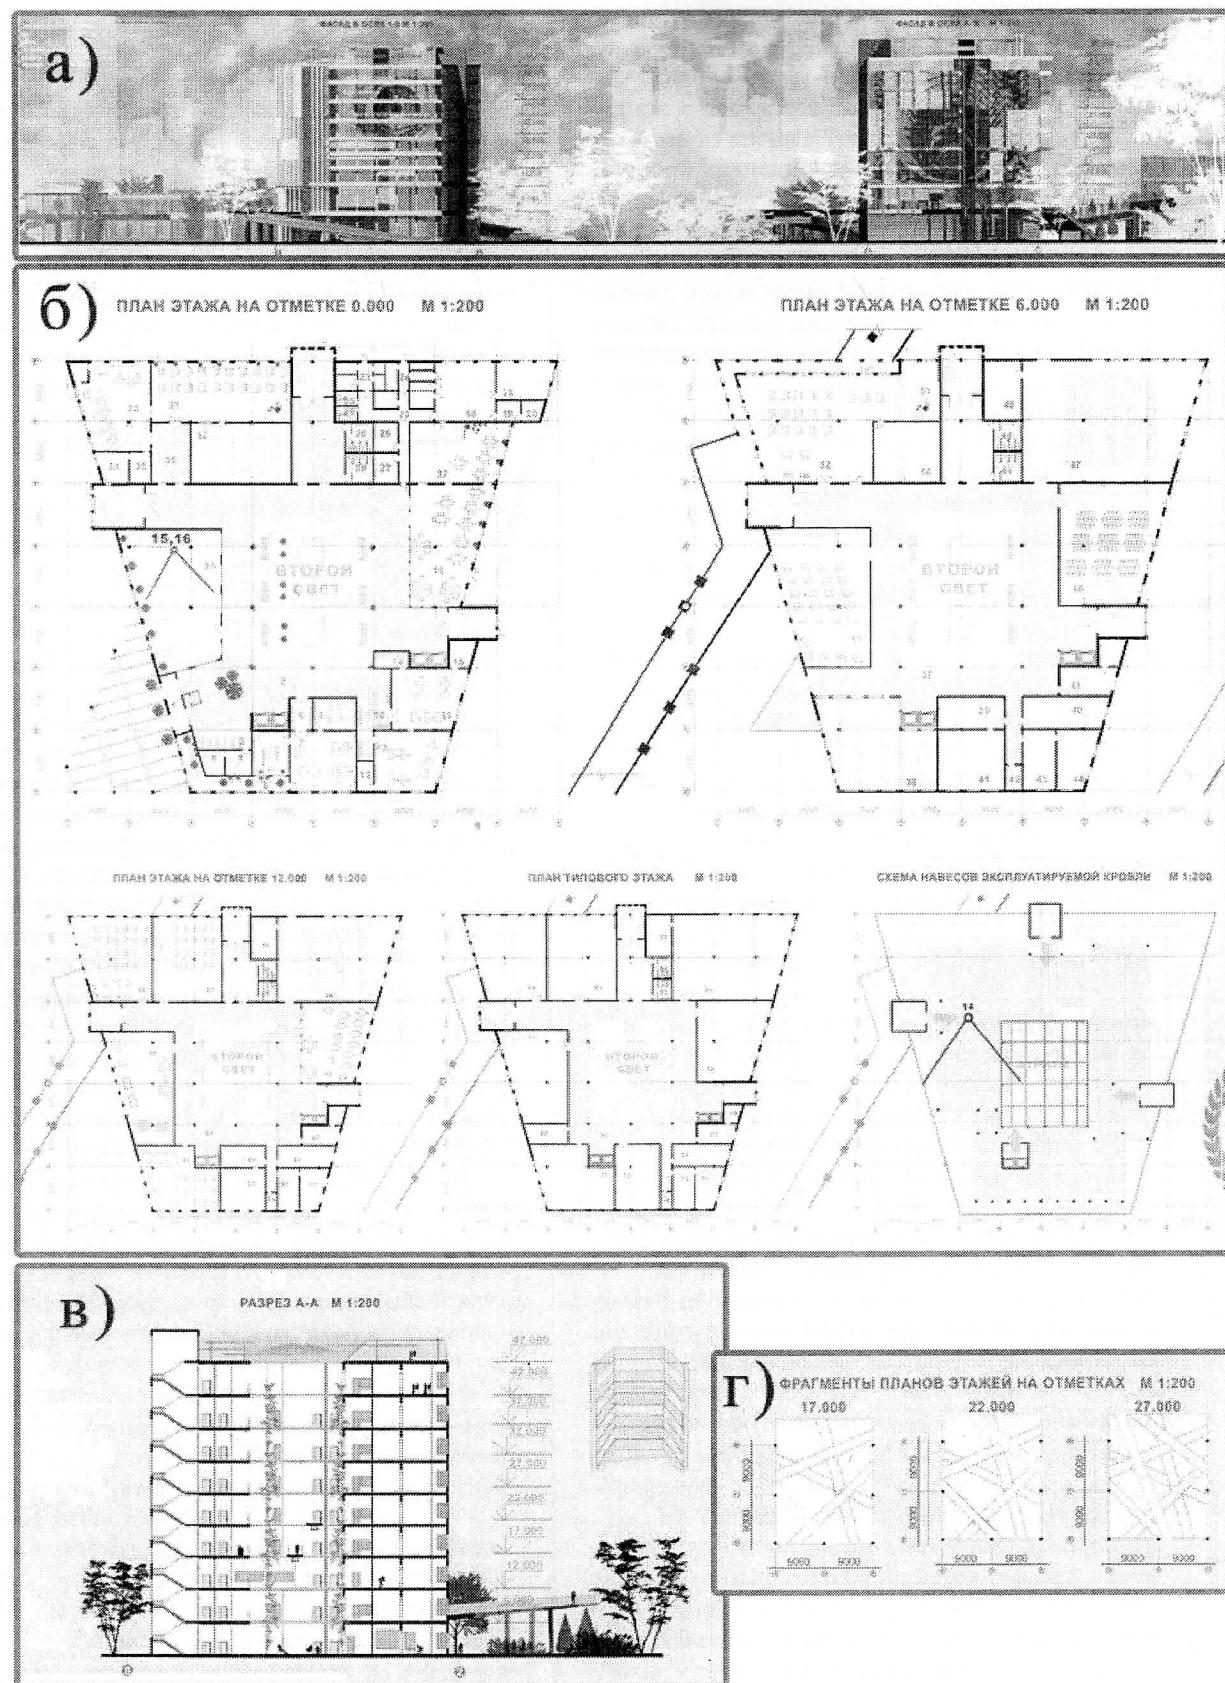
а) Визуалізації фасадів б) Планы этажей в) Разрез г) Фрагменты планов этажей (решение в плане атриумного пространства с переходами)
